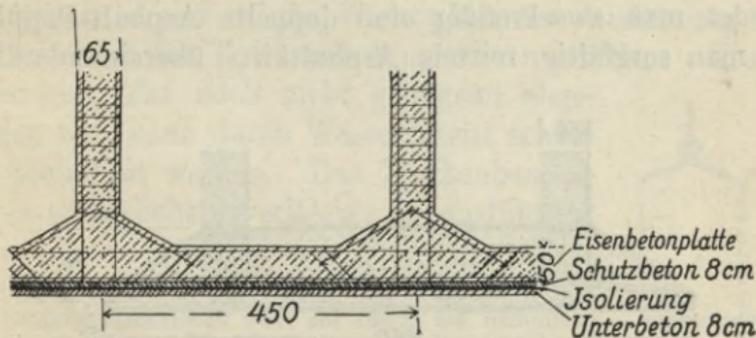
Eisenbetonplatte mit Grundwasserabdichtung.
